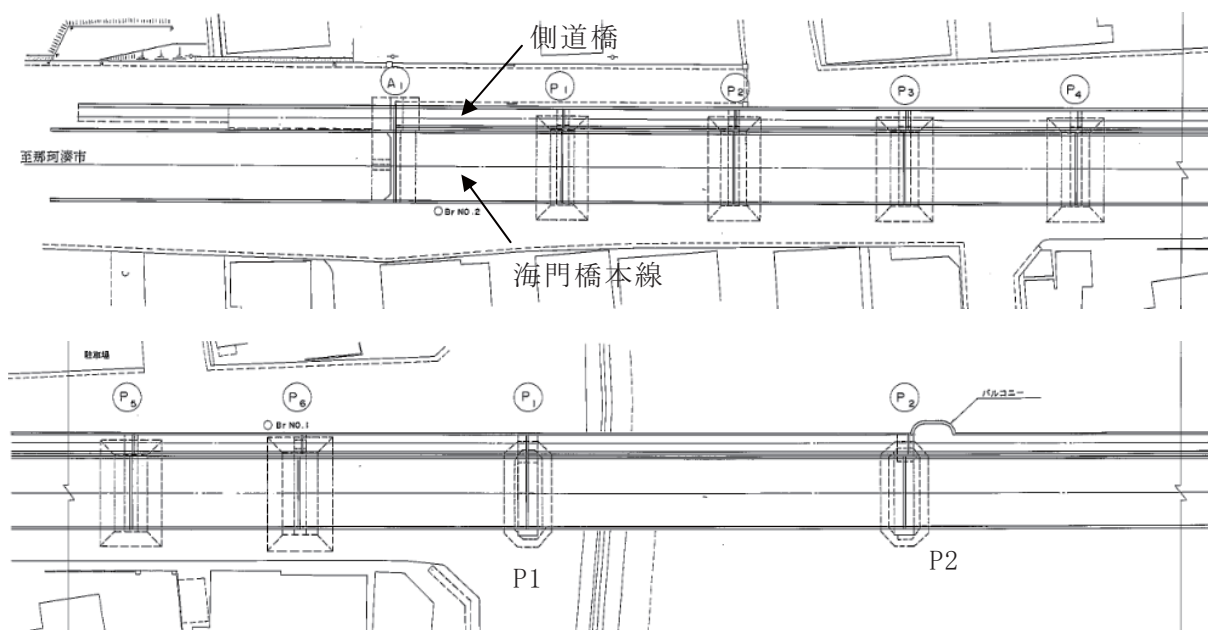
(1) 平面圖(海門橋側道橋)
